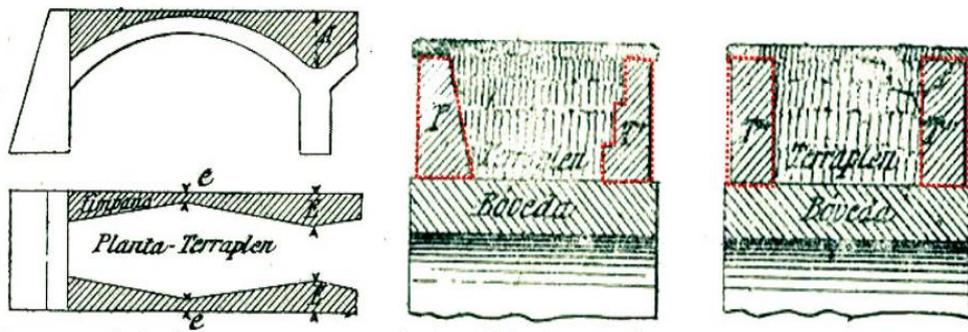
Alzado, planta y secciones transversales típicas de los tímpanos
